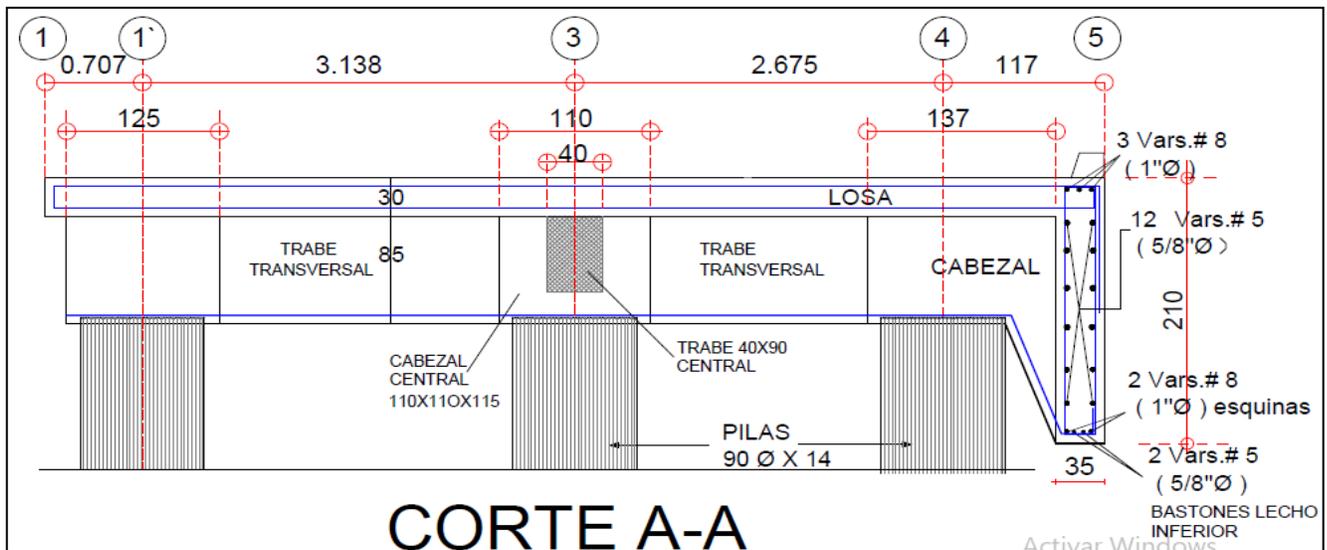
Armado de Trabe Transversal con bastones de lecho inferior (Plano Ejecutivo # 5)
